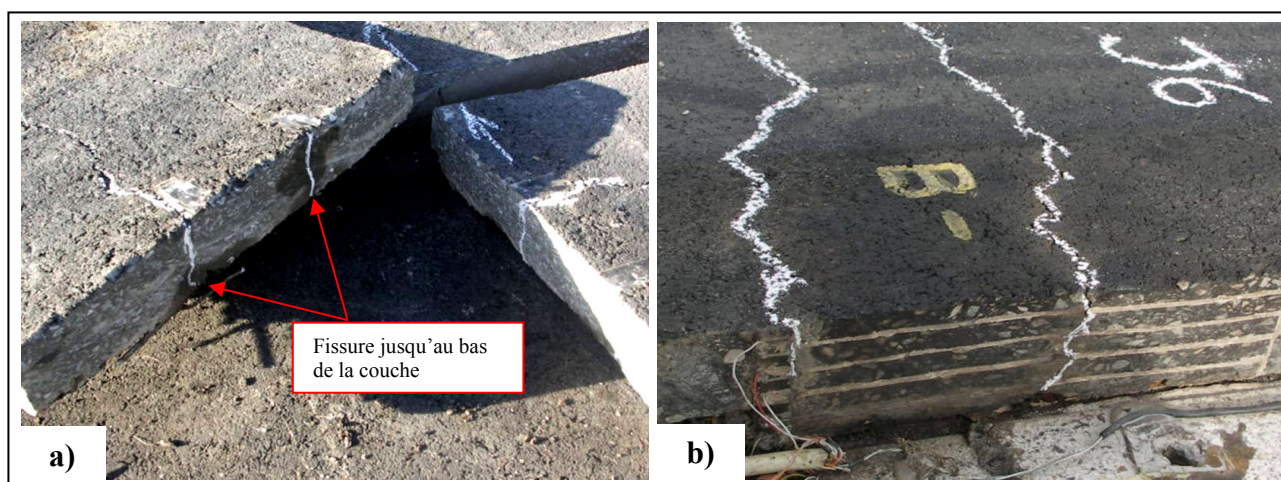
Fissuration de la couche d'enrobé du joint N° 6 sur toute son épaisseur repérée (a) sous le jumelage et (a) sur la face latérale côté sud.
